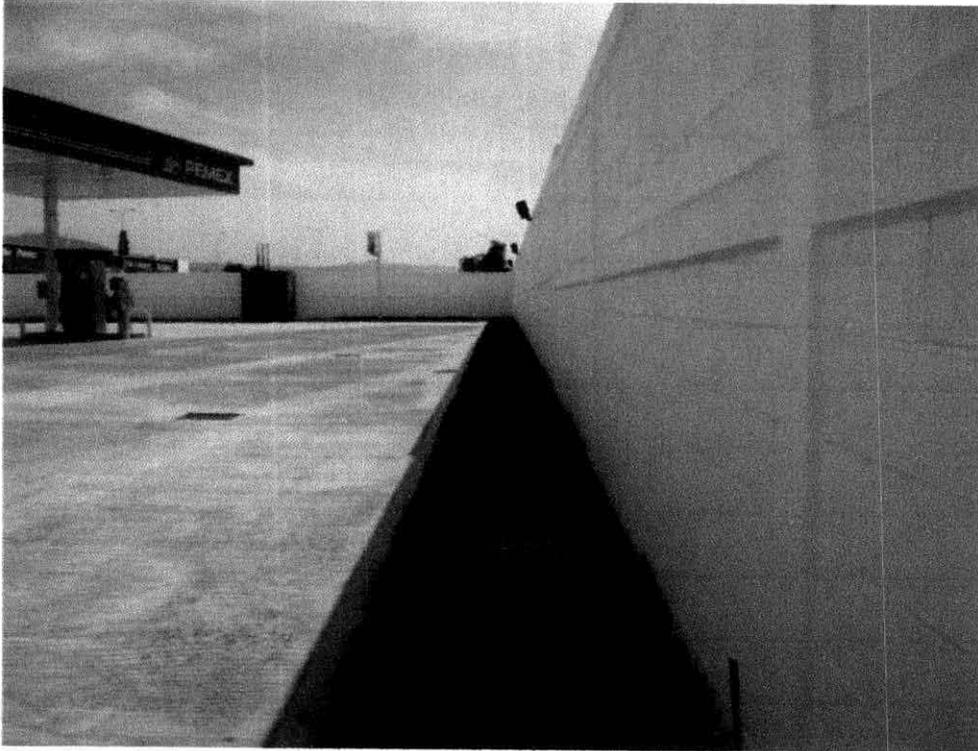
Vista de área verde y barda de colindancia hacia el poniente.
